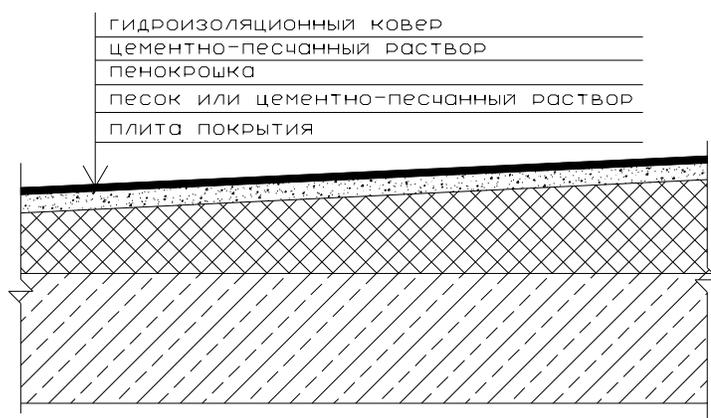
Тепловая изоляция совмещенной плоской кровли из пенокрошки
